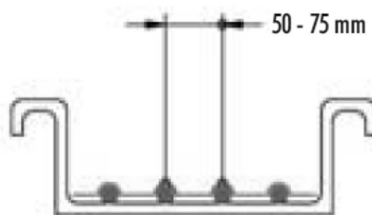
Coupe transversale d'une gouttière corniche avec câble chauffant et entretoise
